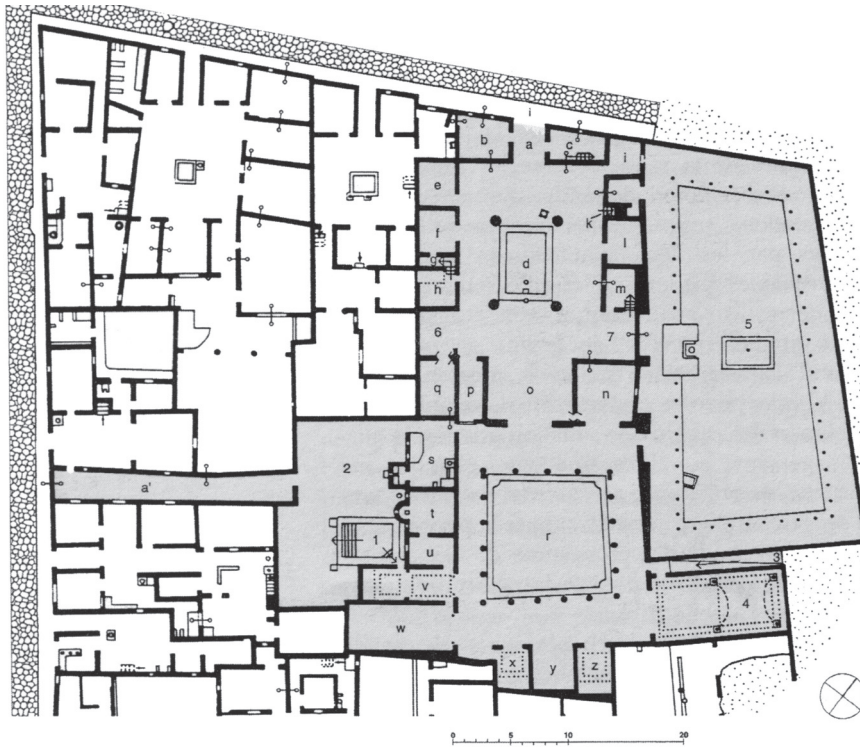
Pompeya, *Casa de las Bodas de Plata*, planimetría (primera mitad del siglo I a.C.).
